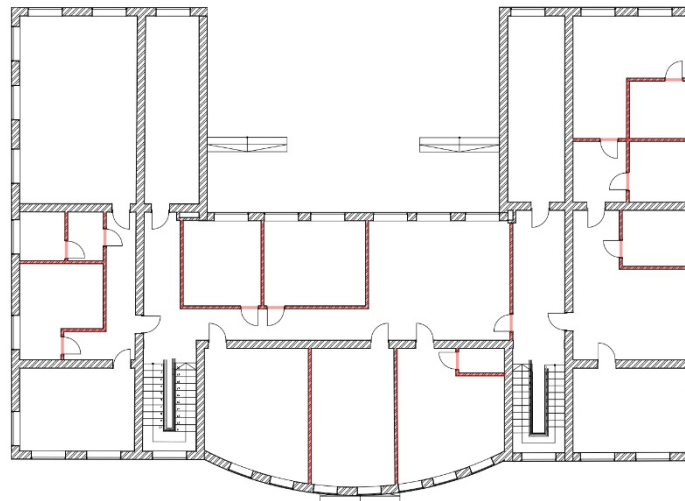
Демонтаж конструкцій план на відмітці +3300 мм
